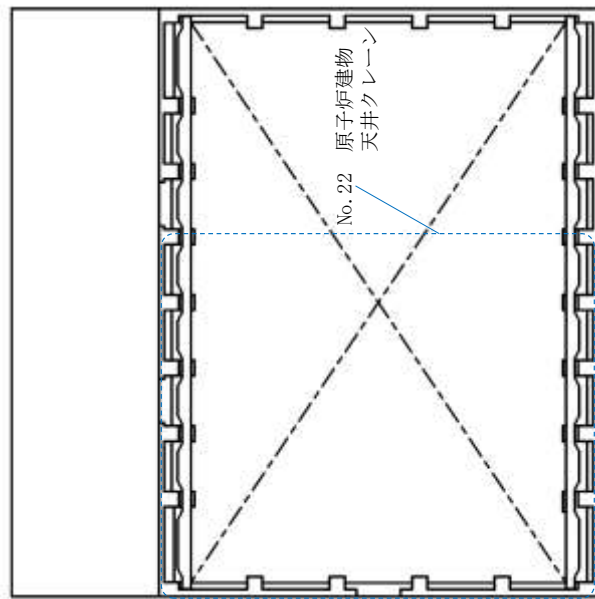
(2) 影響検討対象設備の概略配置図 (平面図 EL. 51.700m)
